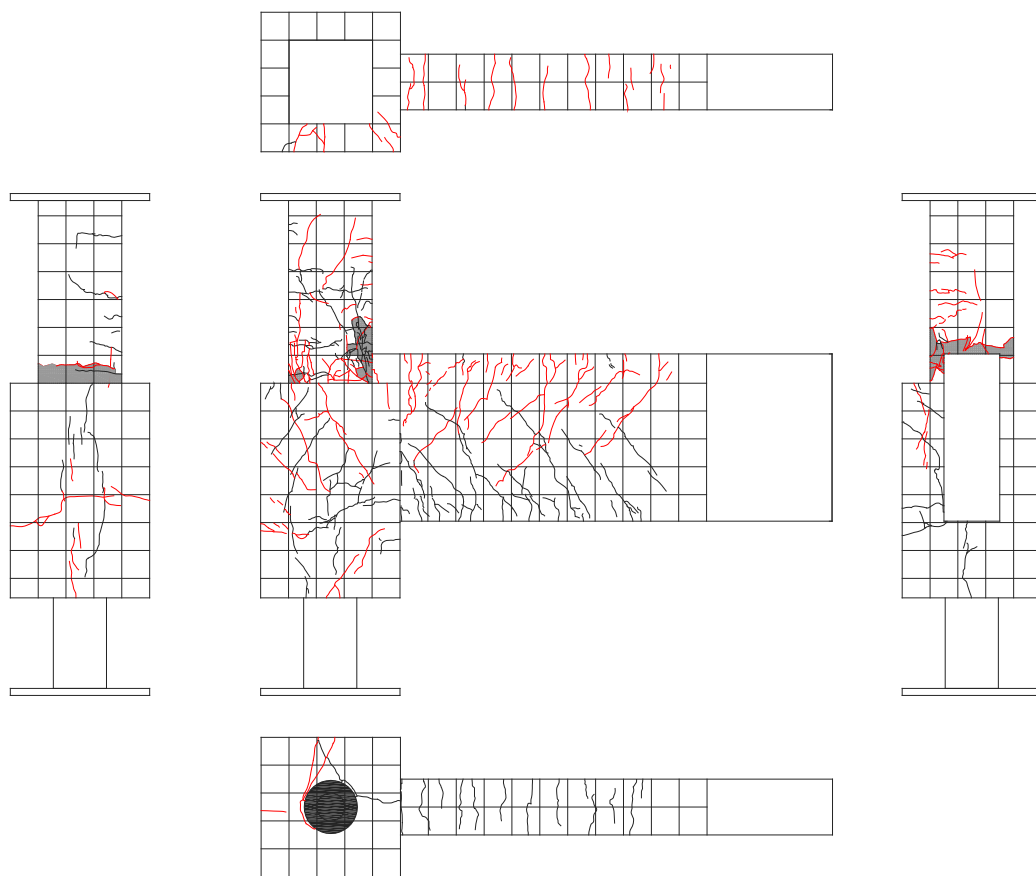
試験体 A-6 ひび割れ状況 (8Cycle)
